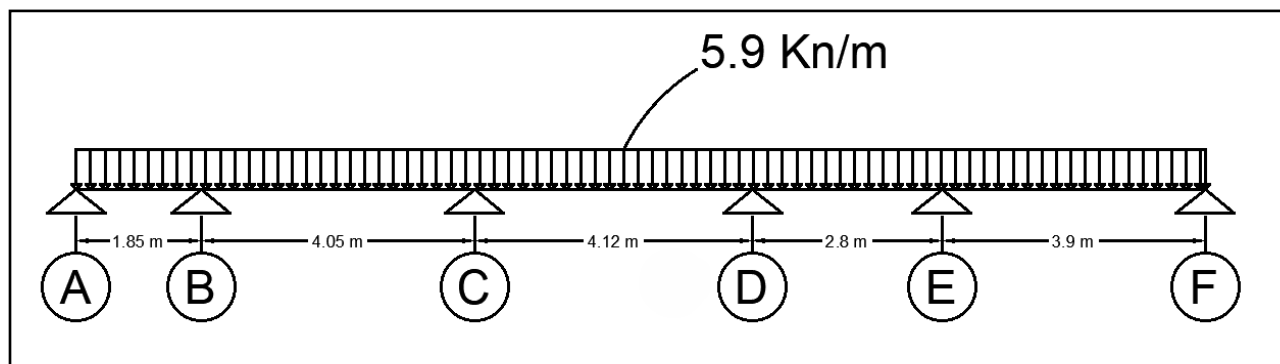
Poutre à cinq travées du plancher Etage courant
